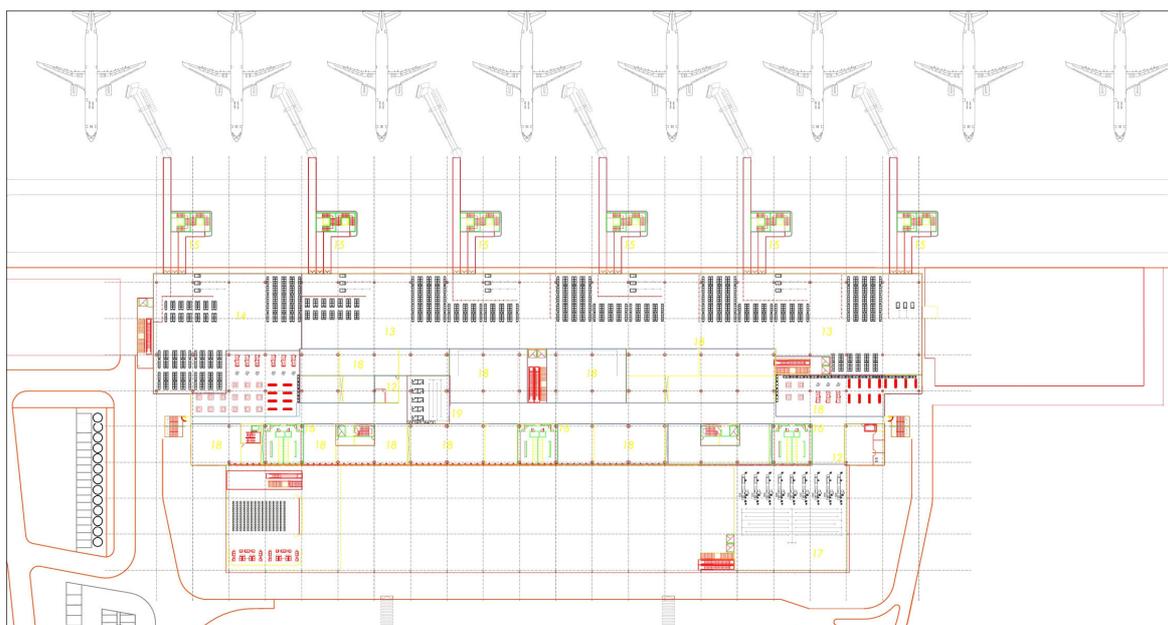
NUOVO TERMINAL – Pianta Piano Primo scala originale 1/500
